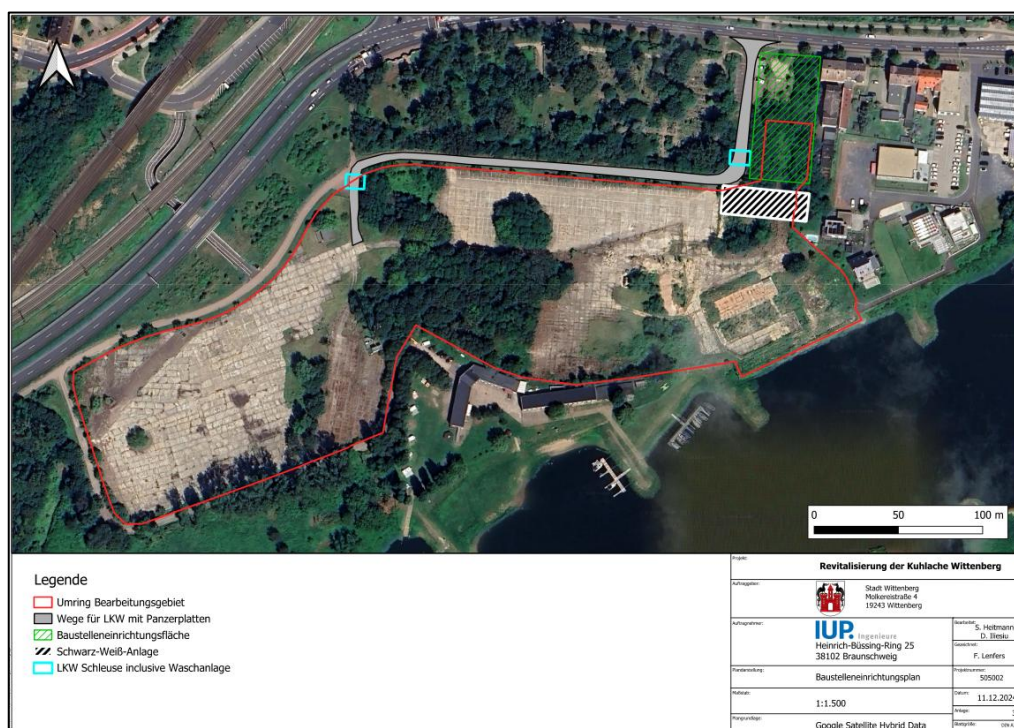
Baustelleneinrichtungsplan der Flächensanierung (IUP (2025)) informativ
